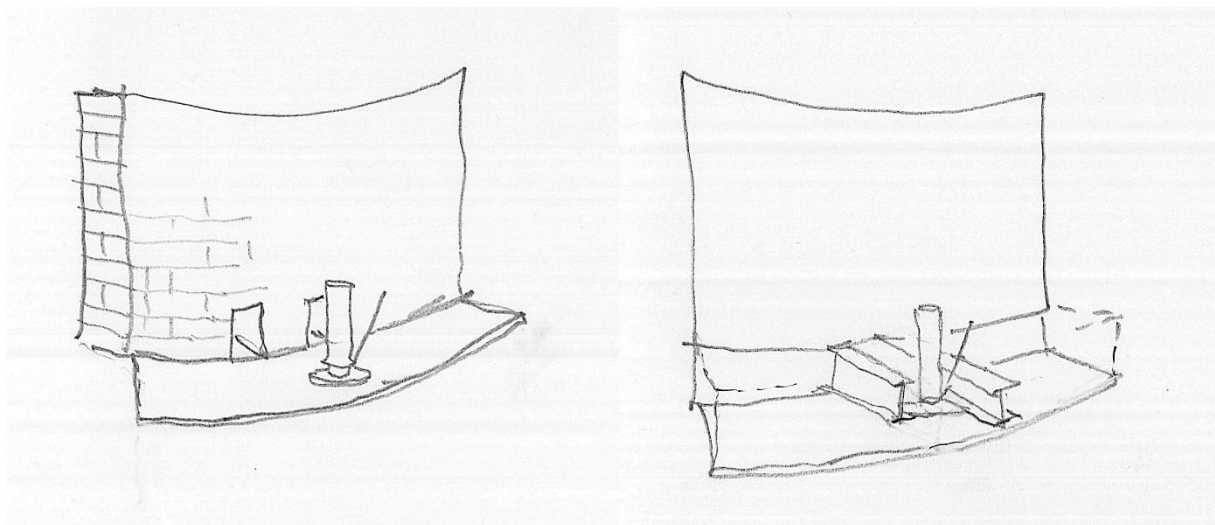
Fasi del consolidamento fondale: predisposizione del cls magro di base e installazione delle putrelle a mensola e del tubo guida.
